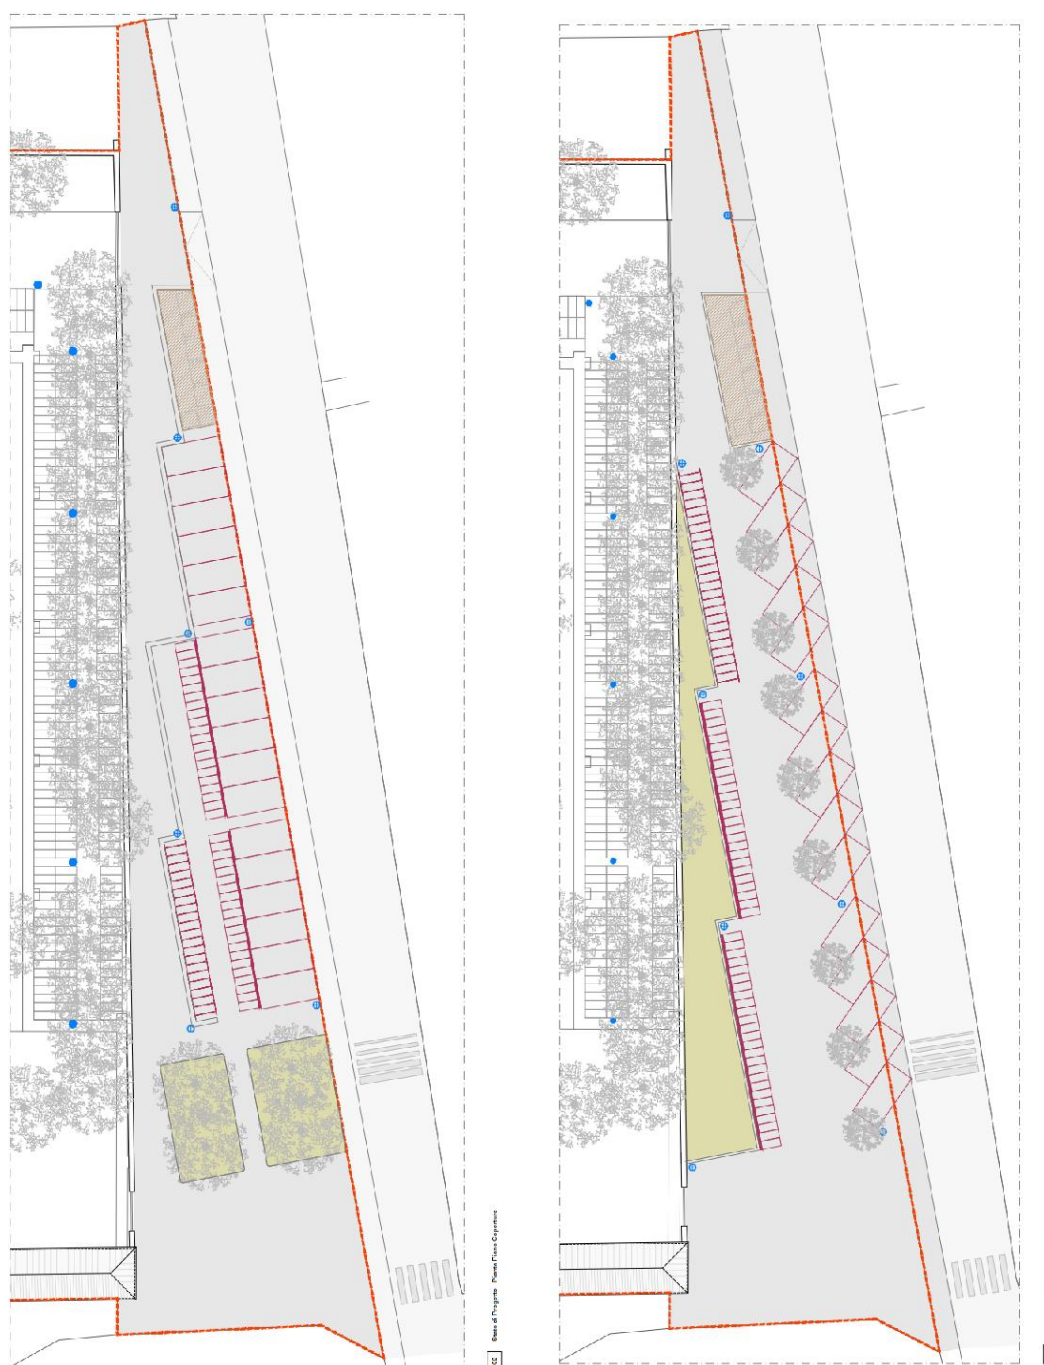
parcheggio esterno riviera Paleocapa – alternative di progetto
